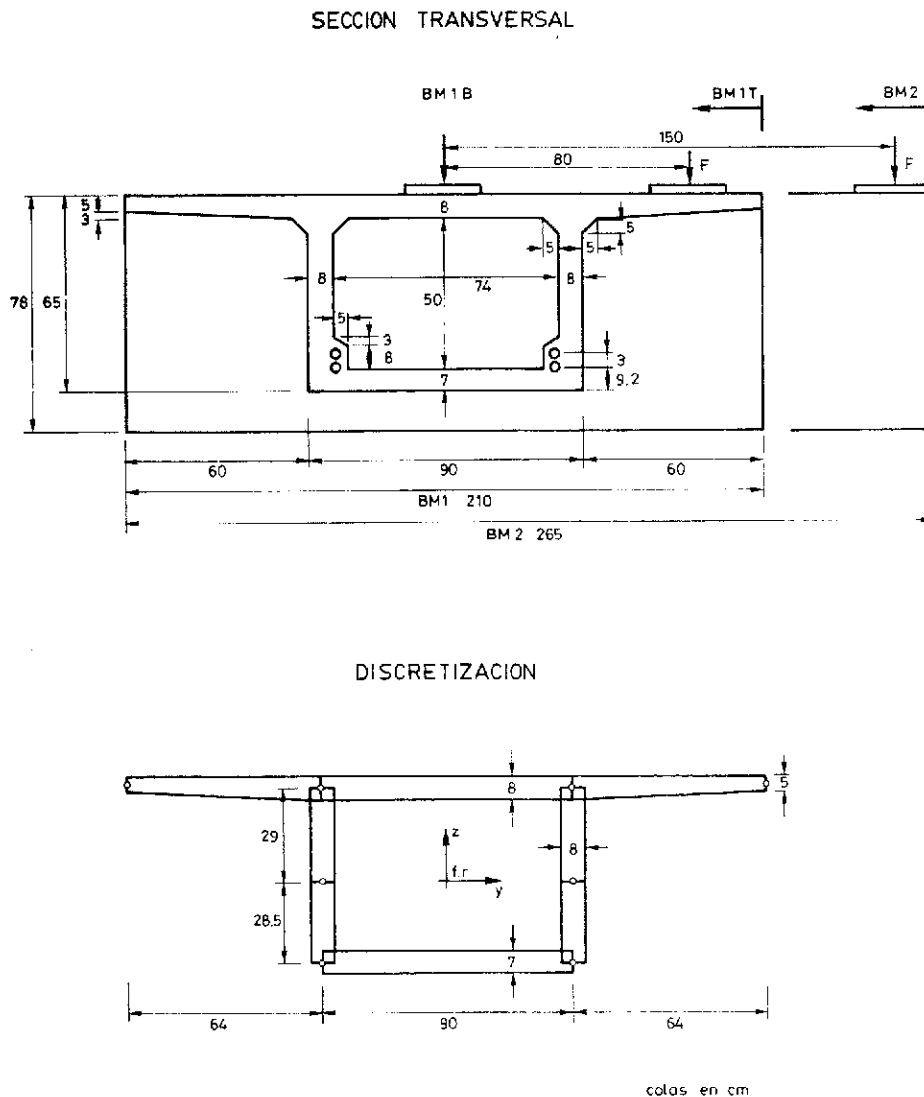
Sección transversal y discretización en paneles de las vigas BM1 y BM2.
